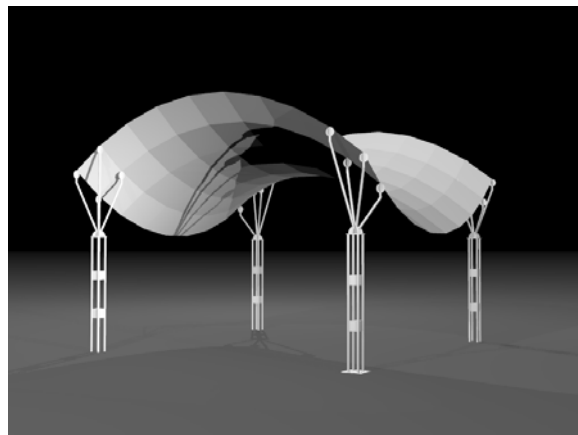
Cubiertas desarrolladas en el Laboratorio de estructuras
